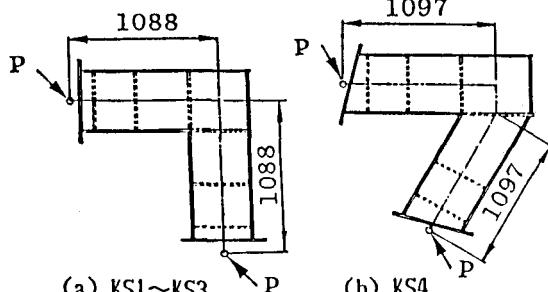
供試体の立面図および載荷方法(寸法単位:mm)
